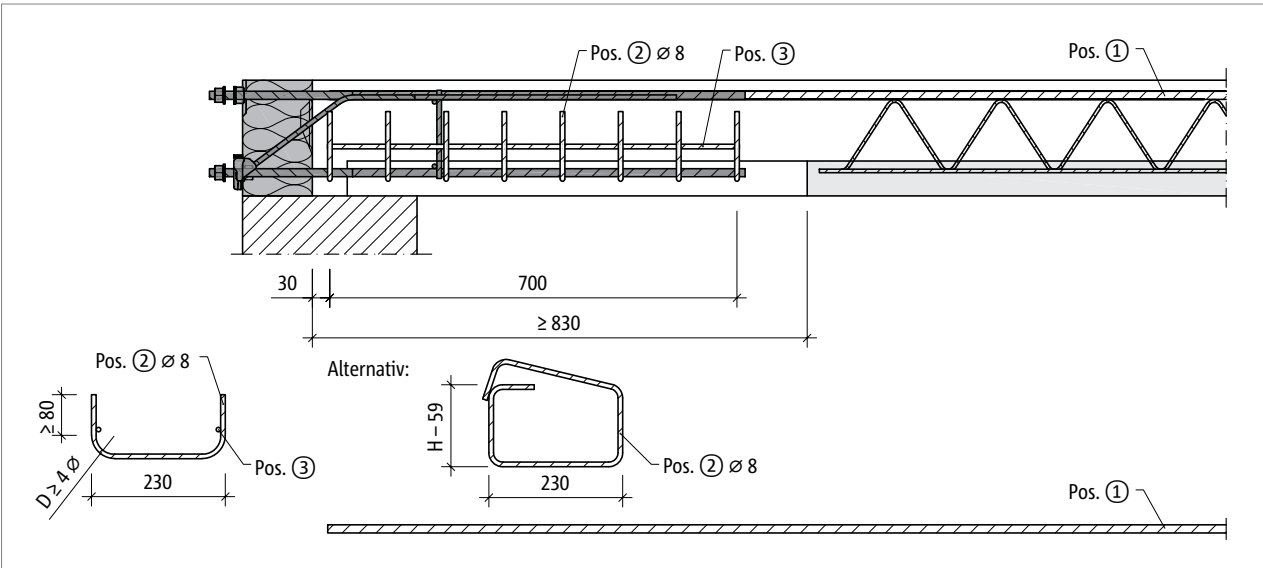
Schöck Isokorb® XT Typ SK-MM1-VV1: Bauseitige Bewehrung bei Halbfertigteilbauweise, Schnitt. Bügelvarianten als konstruktive Querbewehrung in der unteren Deckenbewehrung.
